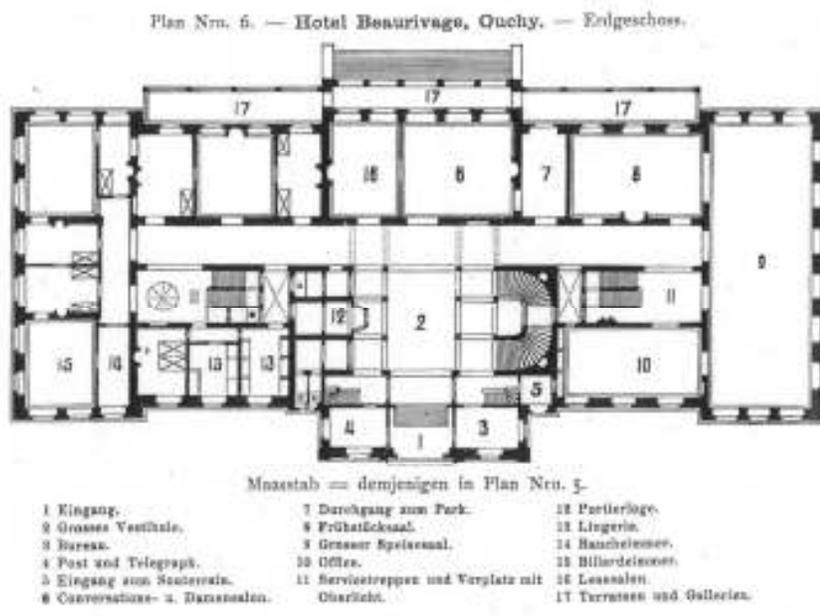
Hôtel Beau-Rivage, Ouchy, Lausanne, Grundriss Erdgeschoss.
